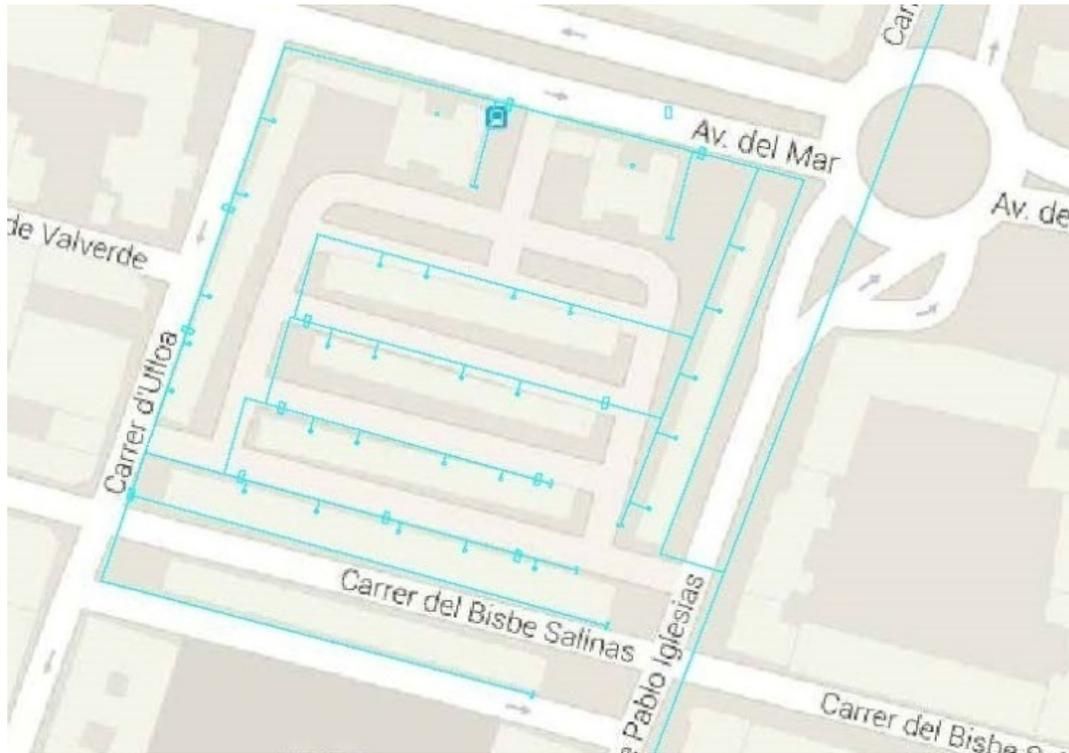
Plano de la red de saneamiento existente en el Grupo 14 de Junio.
